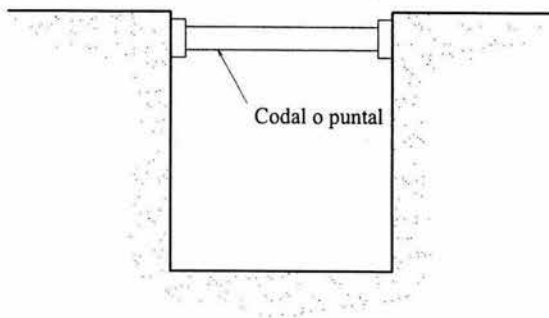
SE EVITAN LAS GRIETAS DE TRACCIÓN CON UN SIMPLE CODAL
